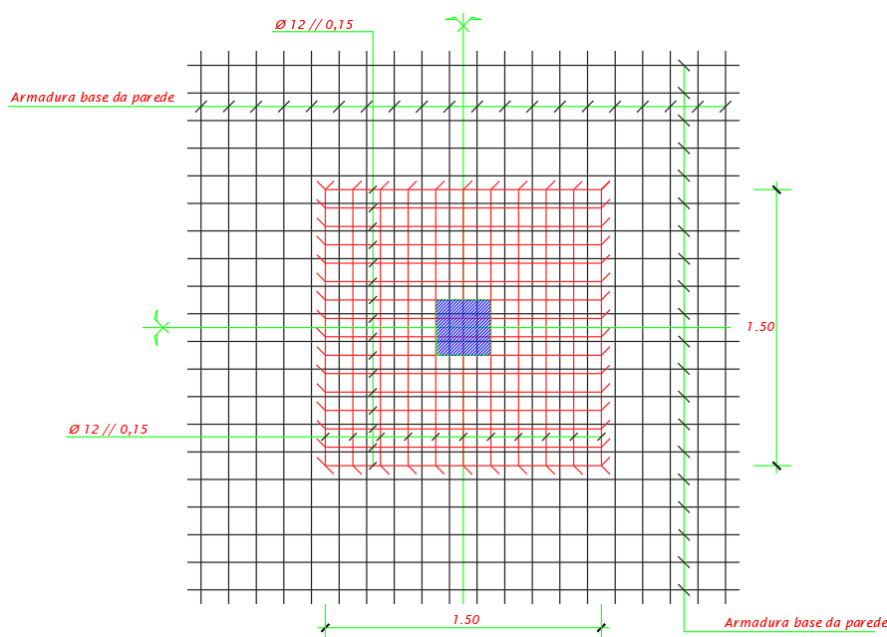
Pormenor do reforço de flexão no local das ancoragens
